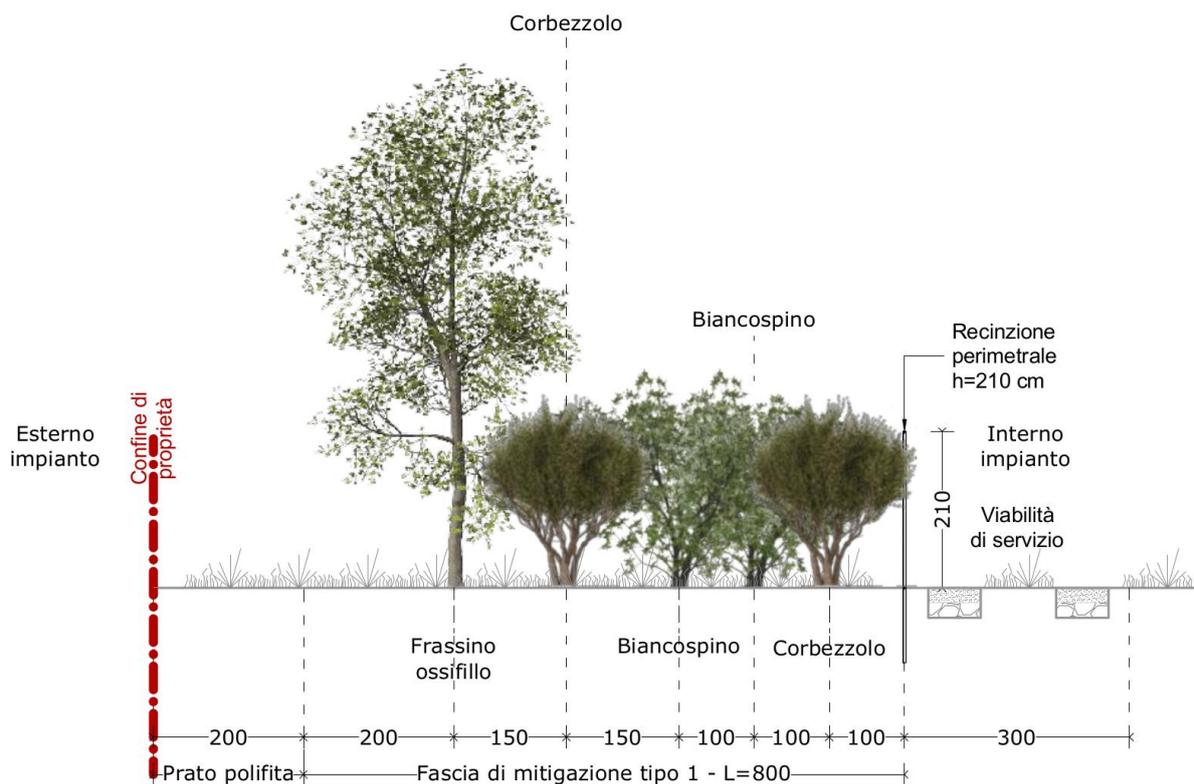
Sezione mitigazioni tipo 1a - campo 1
